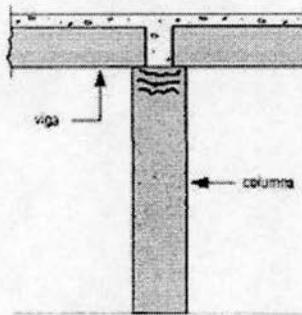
Fisuras de asentamiento plástico
